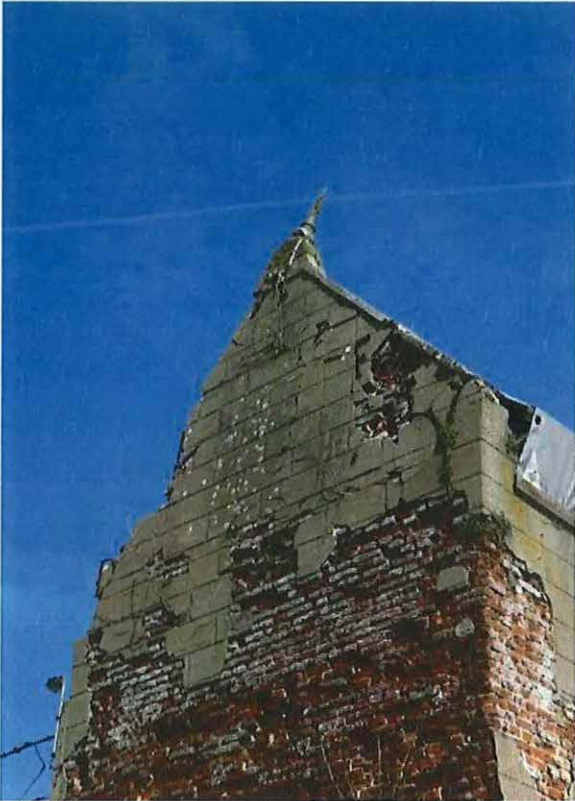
Geveltop achtergevel met loshangende topsteen en kruis in kunstbeton (© Bressers Architecten 22/11/2017).
